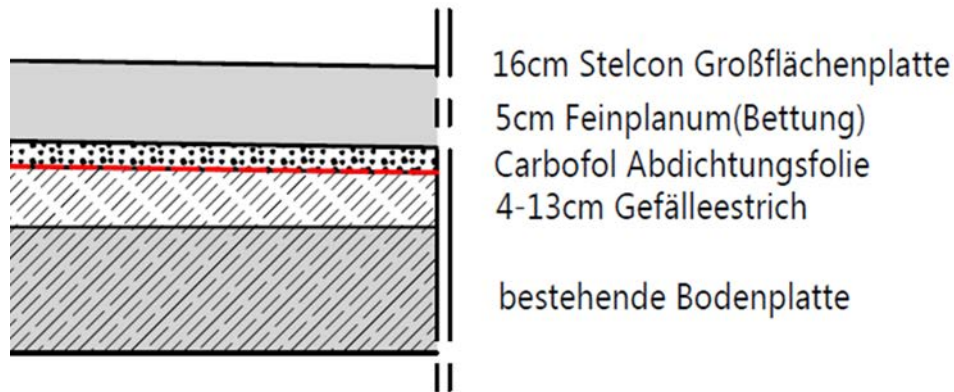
Schnitt des geplanten AwSV-konformen Bodenaufbaus der Lagerhalle L 29.
